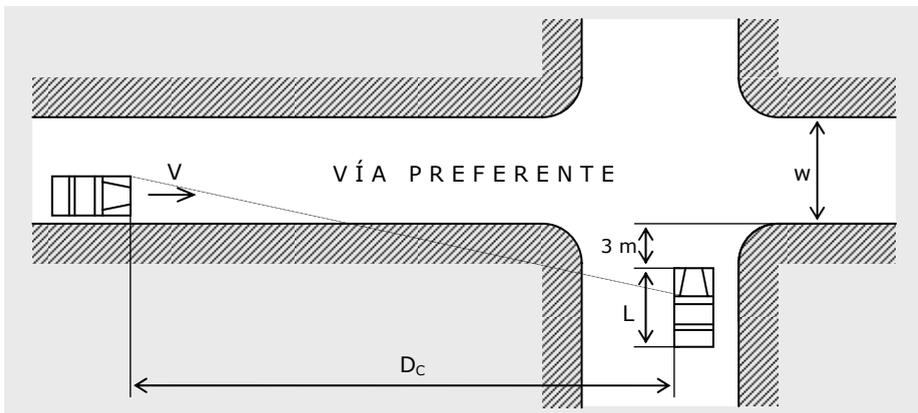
Esquema explicativo de la determinación de la distancia de cruce
